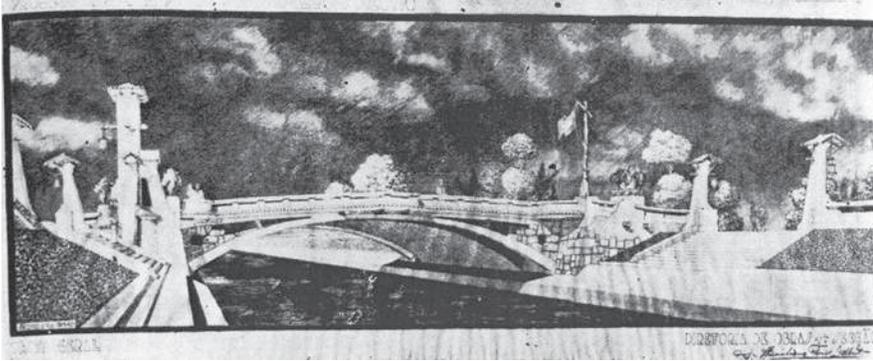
Ponte da Avenida Borges de Medeiros. Vista Geral. (SILVA, 1943, 49)
